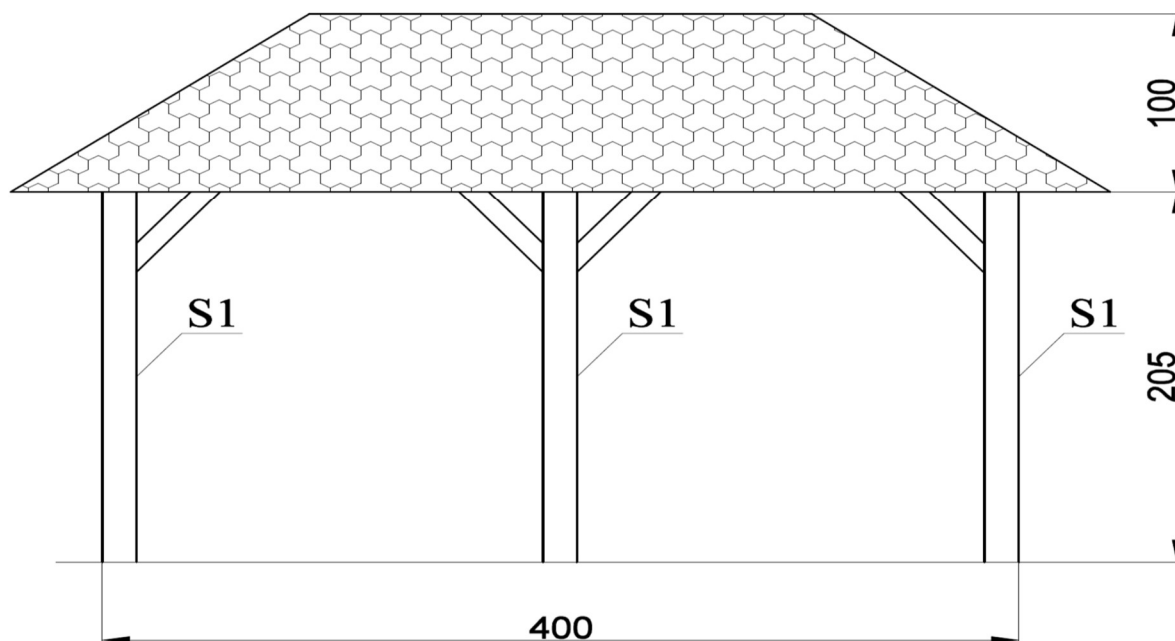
Elewacja frontowa projektowanej altany drewnianej wraz z ławkami i stolikiem – rzut poziomy, S1 – słupy drewniane 15x15 cm, B1 – balustrada do wysokości 97 cm przy wejściu głównym do altany. Na dachu projektuje się pełne deskowanie, pokrycie dachu gontem bitumicznym.
